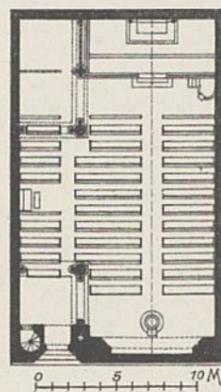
Grundriss zu Abb. 1 u. 2.
